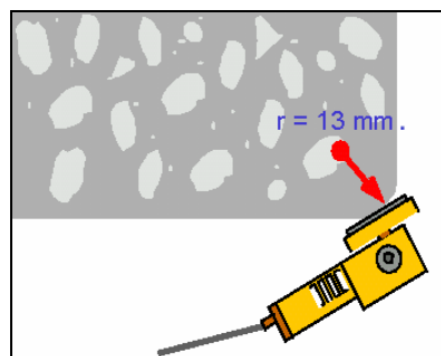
Boleamento das arestas do elemento estrutural (MACHADO, 2006)
